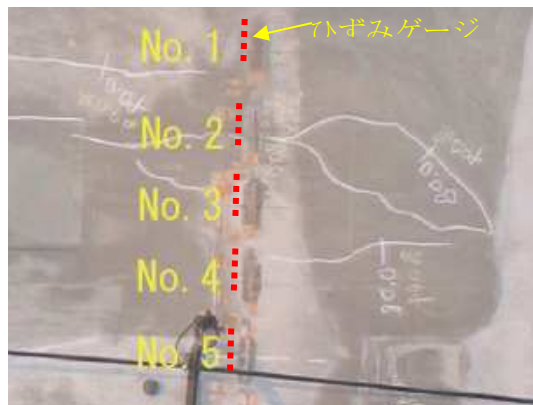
ひび割れ発生状況（冬期施工、B-B断面）
